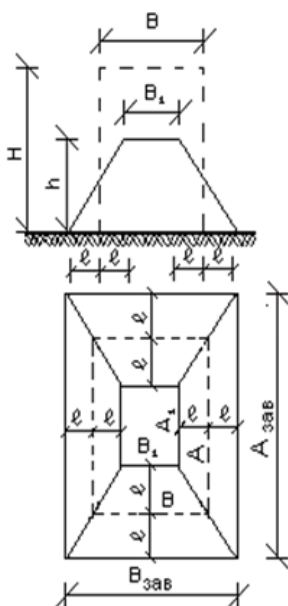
Розрахункова схема завалу при руйнуванні будівлі землетрусом
